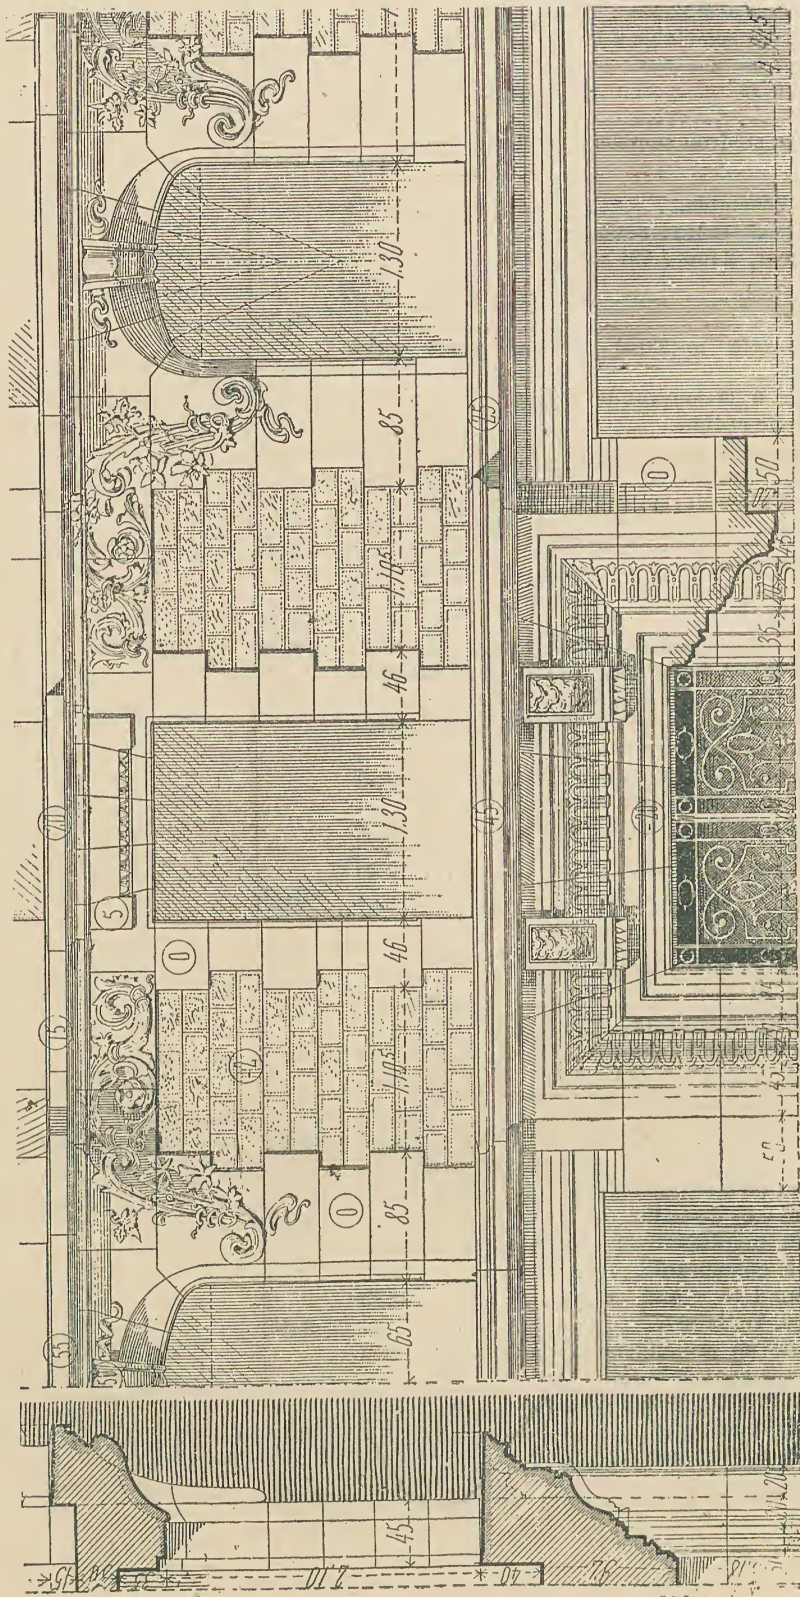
Vue de côté et coupe sur le pan coupé.
